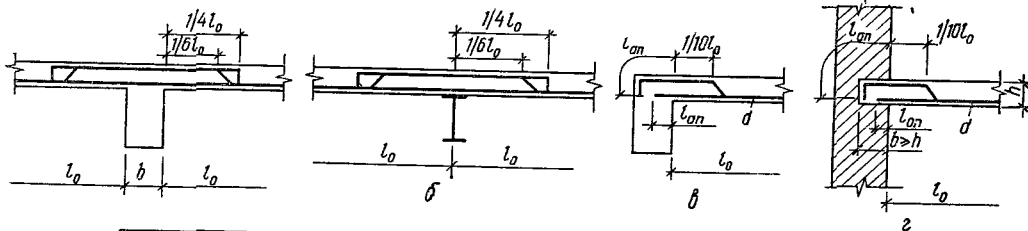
Непрерывное армирование монолитных плит отдельными стержнями (вязаной арматурой): а — средняя опора многопролетной плиты — железобетонная балка; б — то же, стальная балка; в — крайняя опора — железобетонная балка; г — то же, кирпичная стенка; 1 — отгибы; 2 — дополнительная надопорная арматура (ставится, если недостаточно отогнутых стержней); 3 — пролетная арматура.
